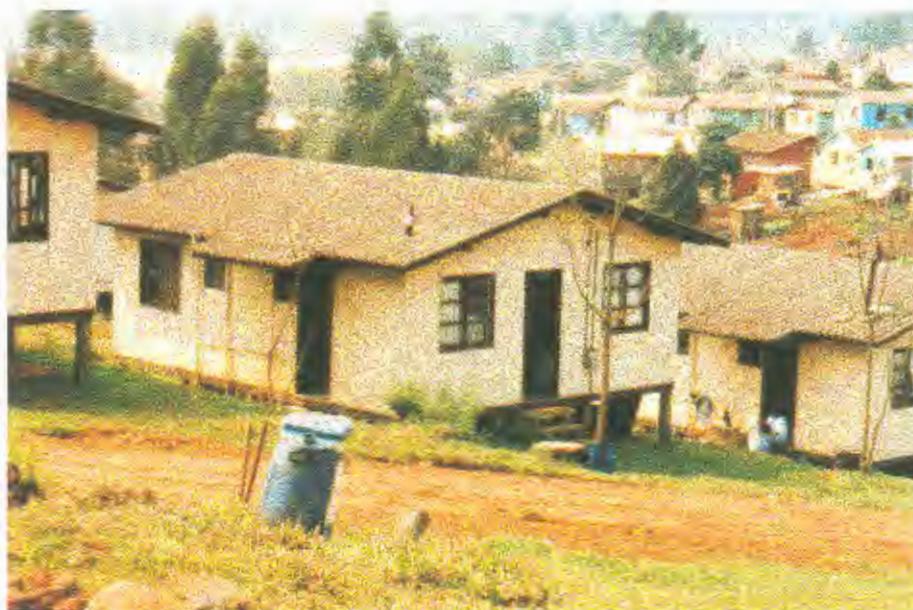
Vista da Casa de Planta Baixa Tipo 1.
